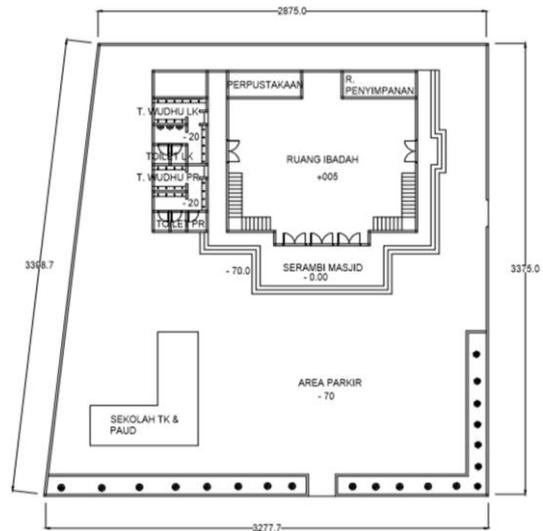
Denah Eksisting Masjid At- Taqwa
